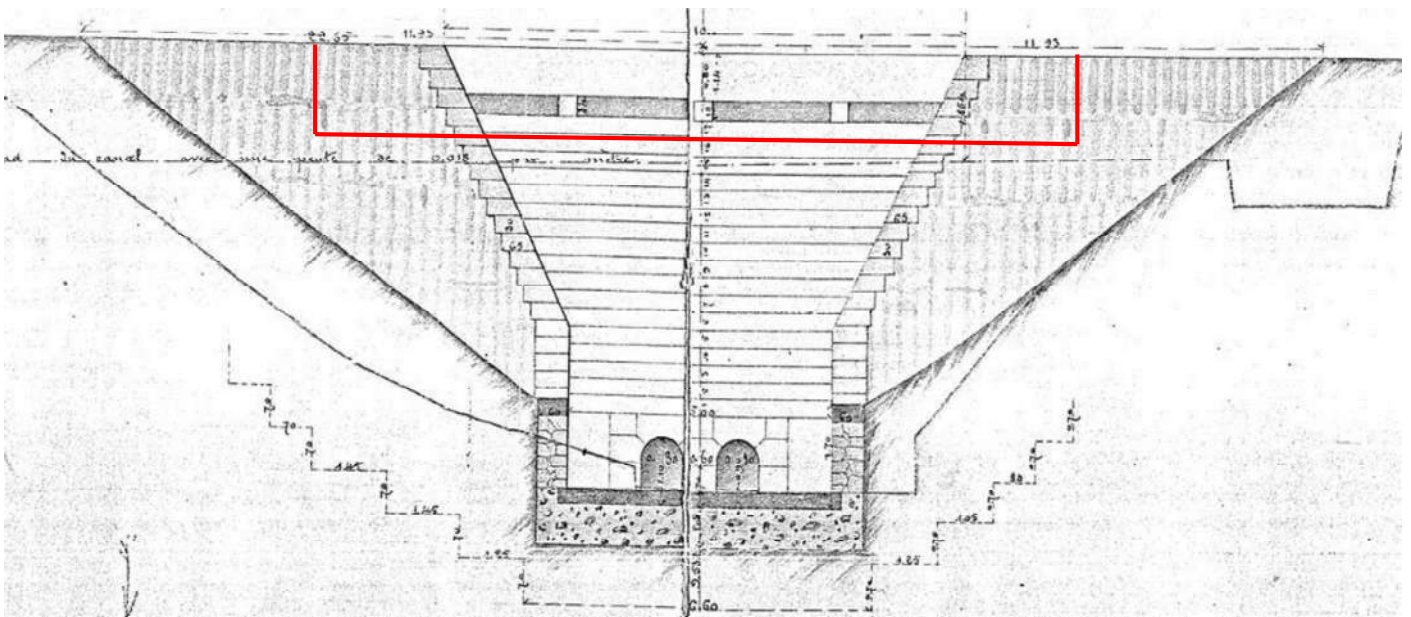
SCHÉMA DE L'AMÉNAGEMENT C : ÉLARGISSEMENT DU DÉVERSOIR DE CRUE ET ARASEMENT DE LA CRÊTE DE L'OUVRAGE
